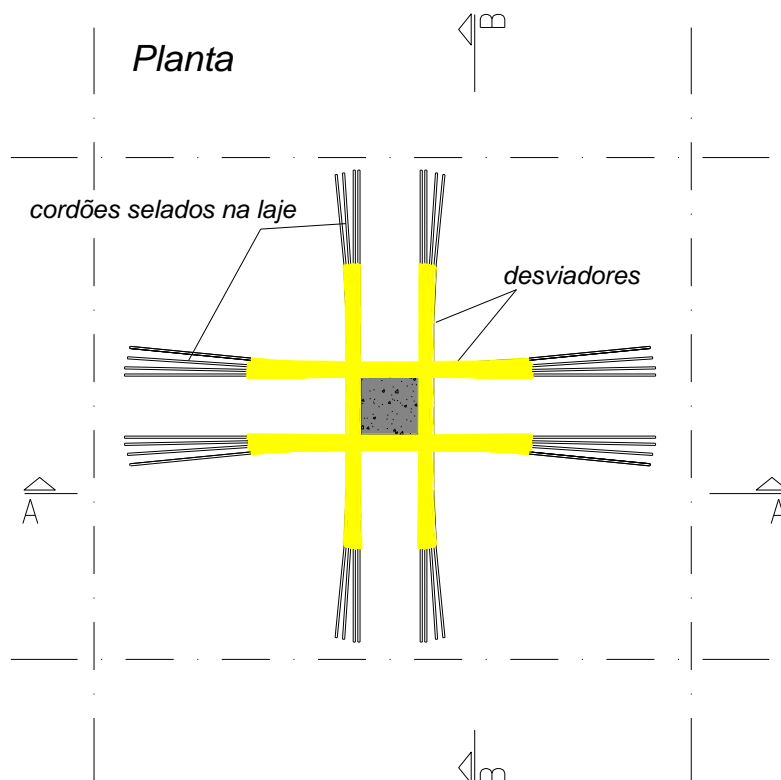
Pormenorização do reforço em planta no pilar P1 (desenho sem escala e dimensões em mm).
